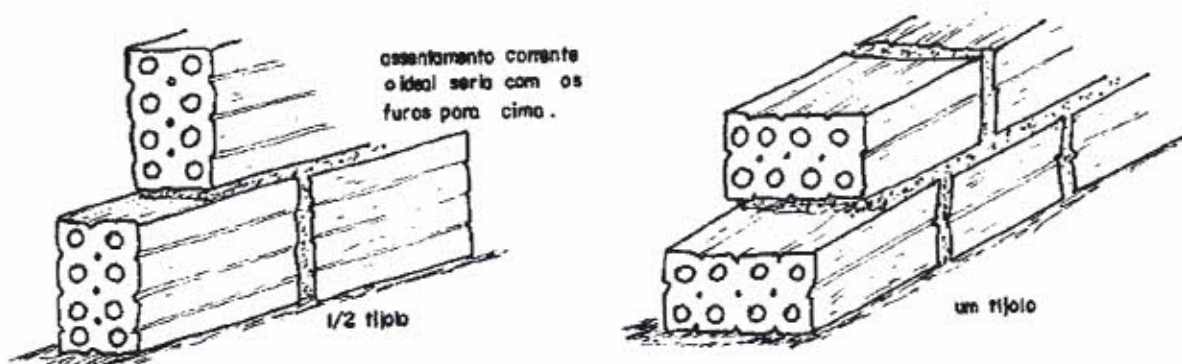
Execução de alvenaria utilizando tijolos furados.
